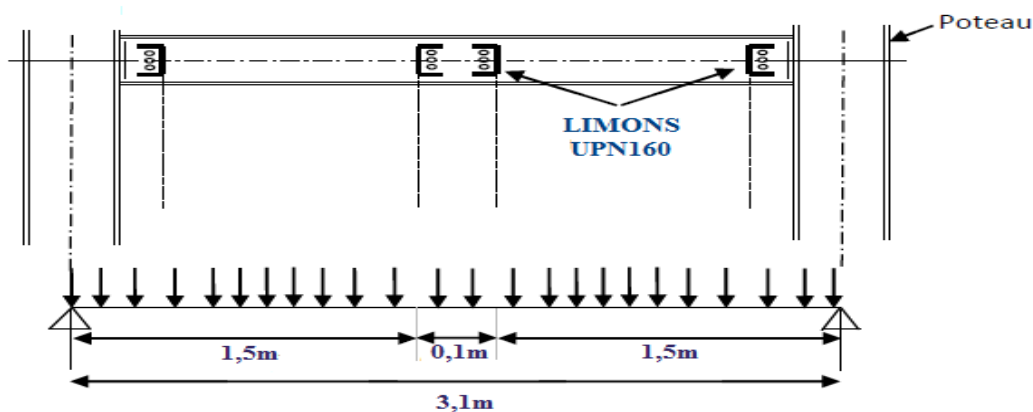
Les charges sur la poutre d'appuis des limons
